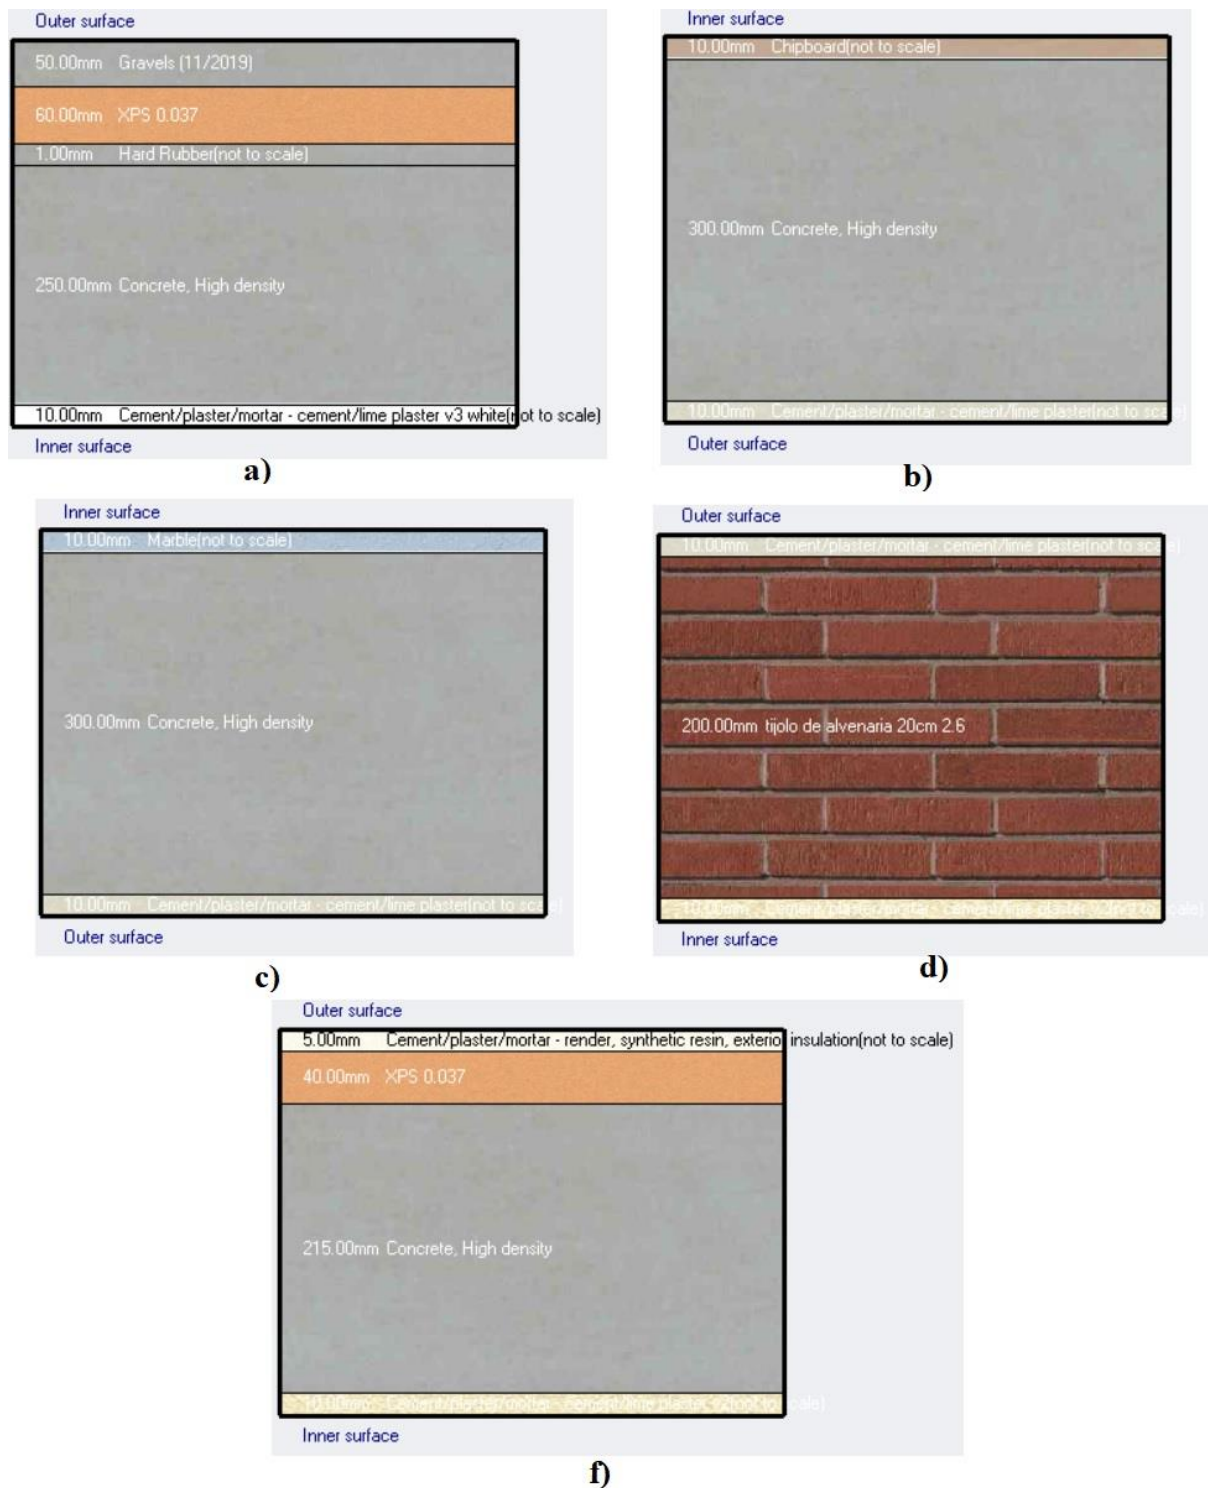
Secções dos elementos construtivos: a) Laje de cobertura; b) Laje interior na sala; c) Laje interior no corredor; d) Parede interior; f) Parede Exterior.
